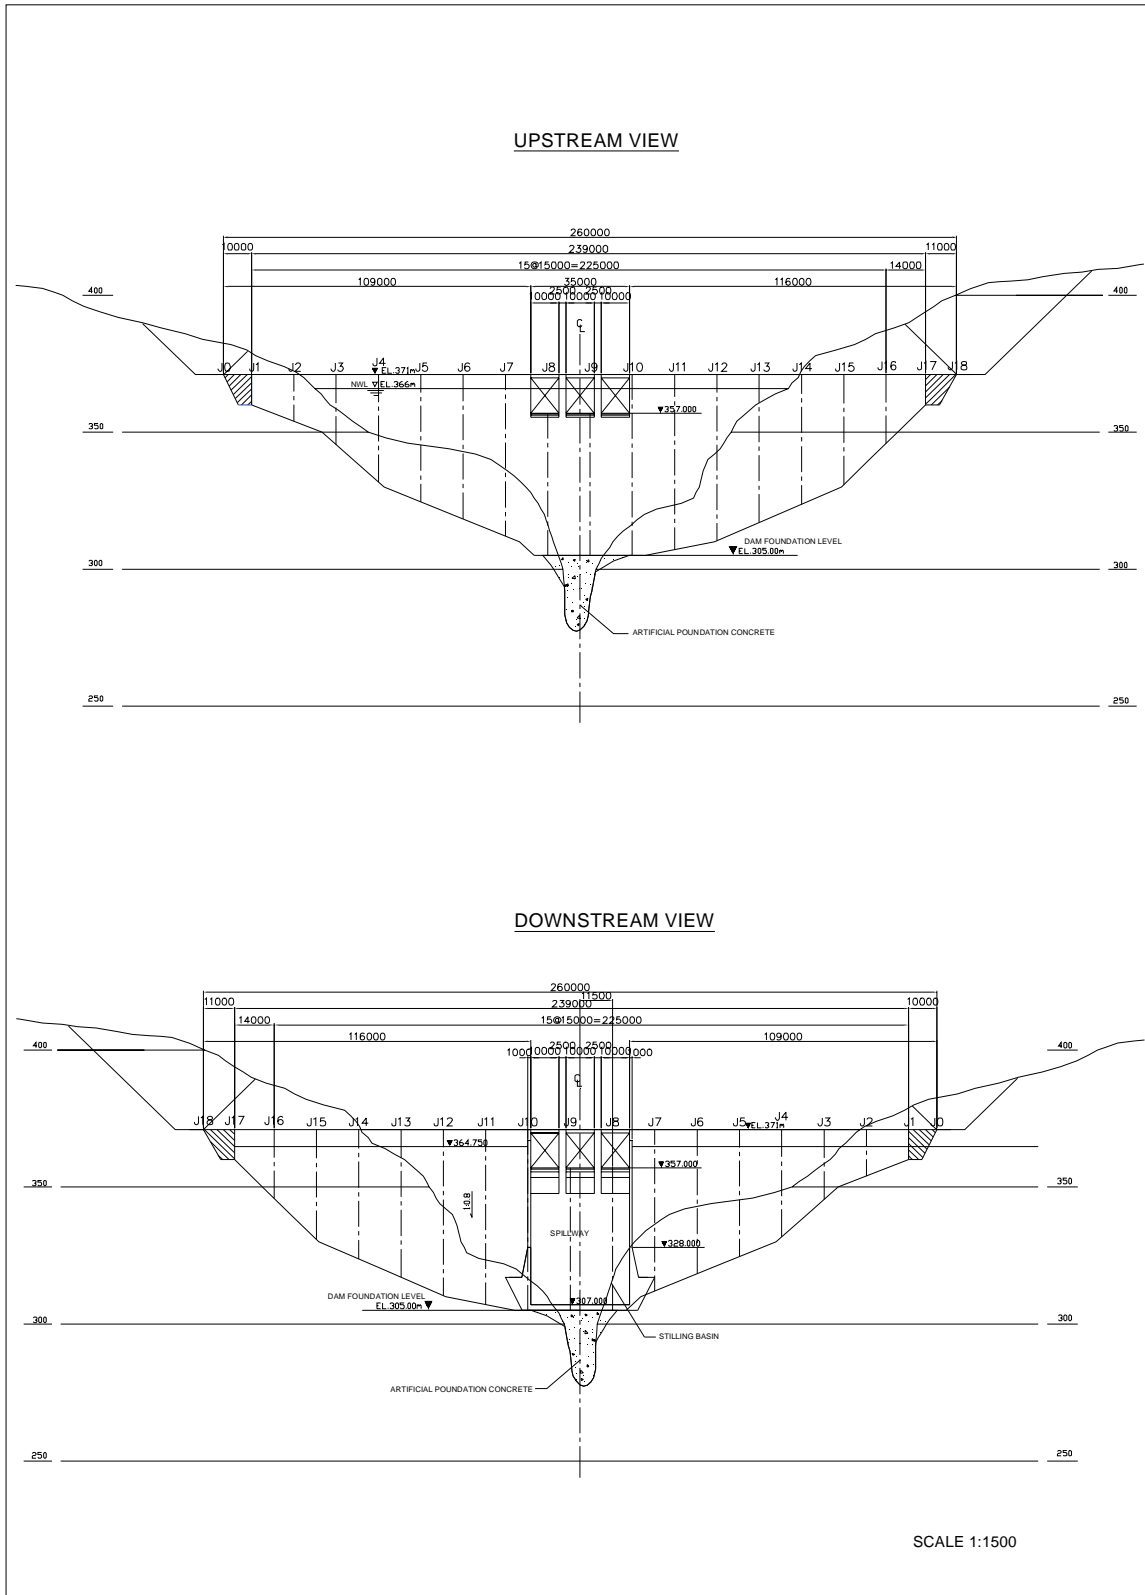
Rencana Reservoir Dam Ayung
